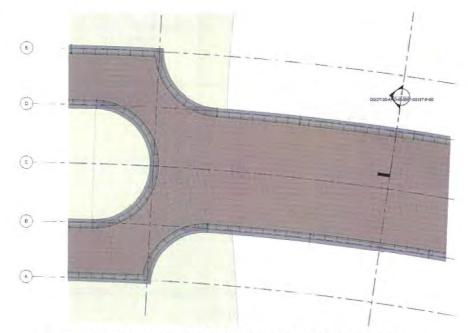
Vista en planta de barandal sobre la pasarela.
